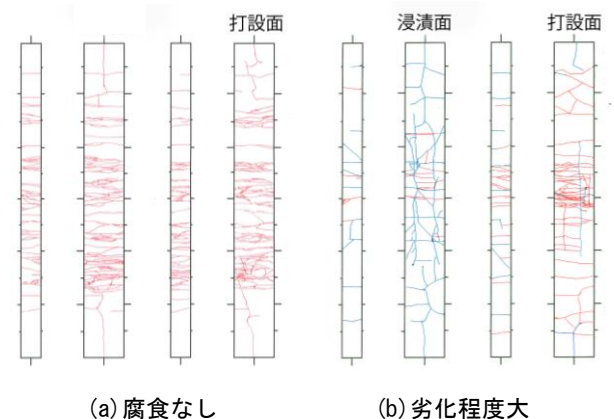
SHCC 供試体ひび割れ図 (C=20mm)
